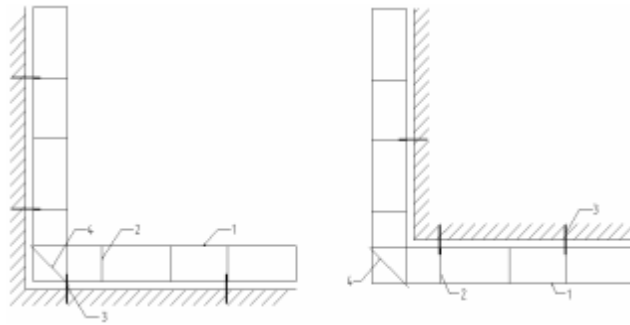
作业脚手架竖向斜撑杆布置示意
